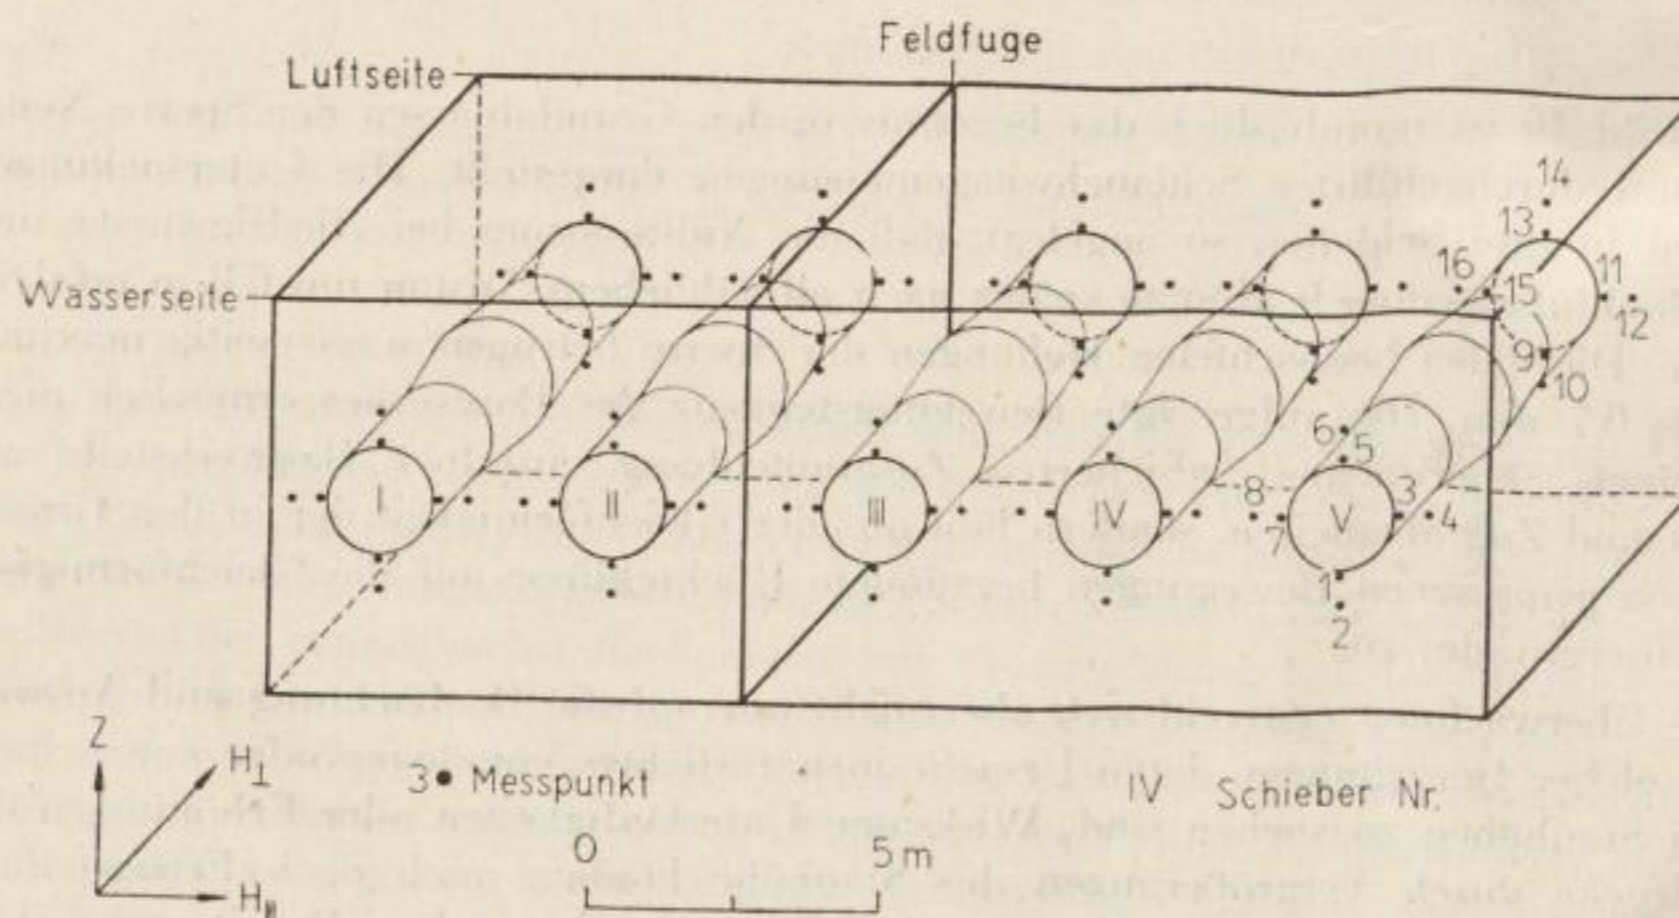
Räumliche Darstellung des Schieberraumes am Abschlußbauwerk Bräsinchen
